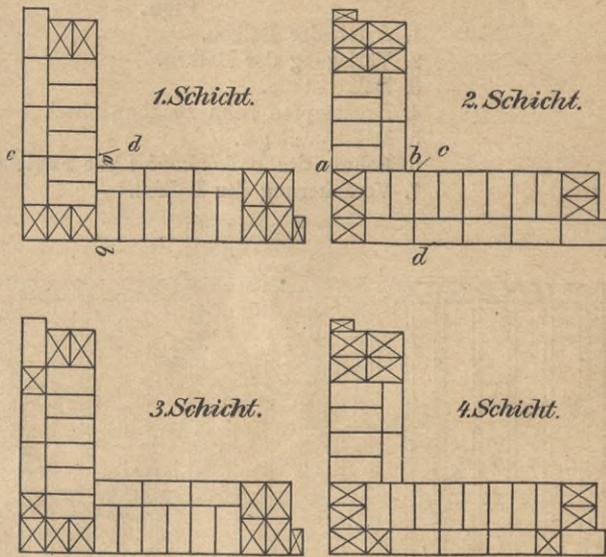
Rechtwinklige Mauerecke und Mauerende mit Anschlag, 1 1/2 Stein stark.
